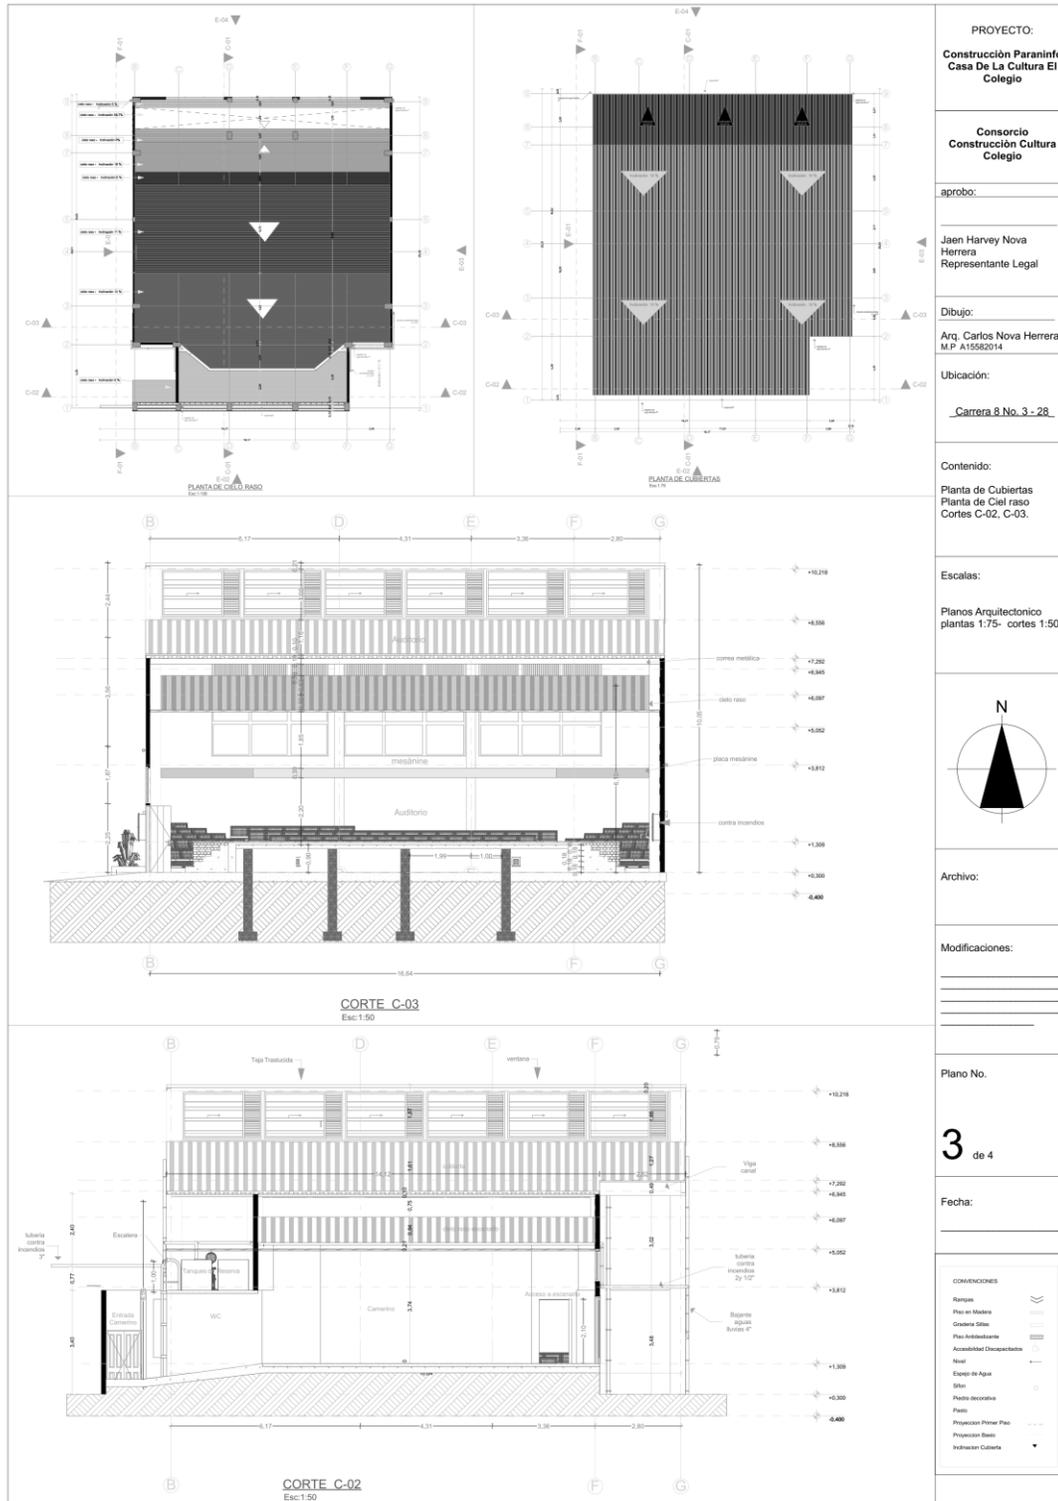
/ Parainfo, Planos record, cortess, cubiertas / Propio
